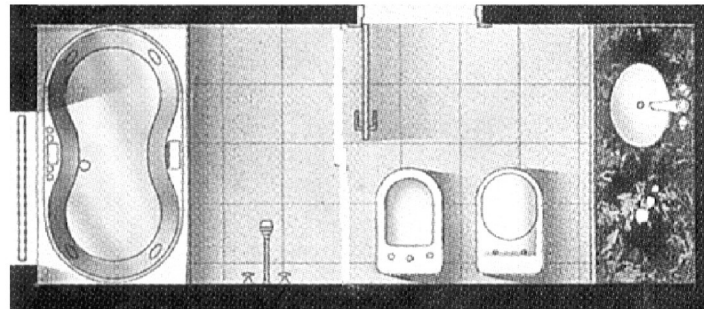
Layout de banheiro onde a banheira de hidromassagem ocupa um lugar separado do box, porém ao lado; exemplo oriundo de planta de 121 m² e tipologia 3.0/311, Country Residence, Curitiba
